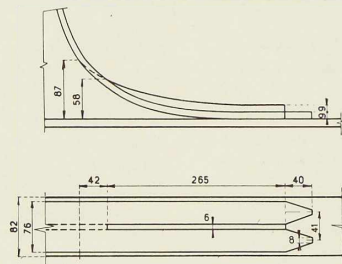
Détails de construction du nœud type n° 6 (fig. 312).
